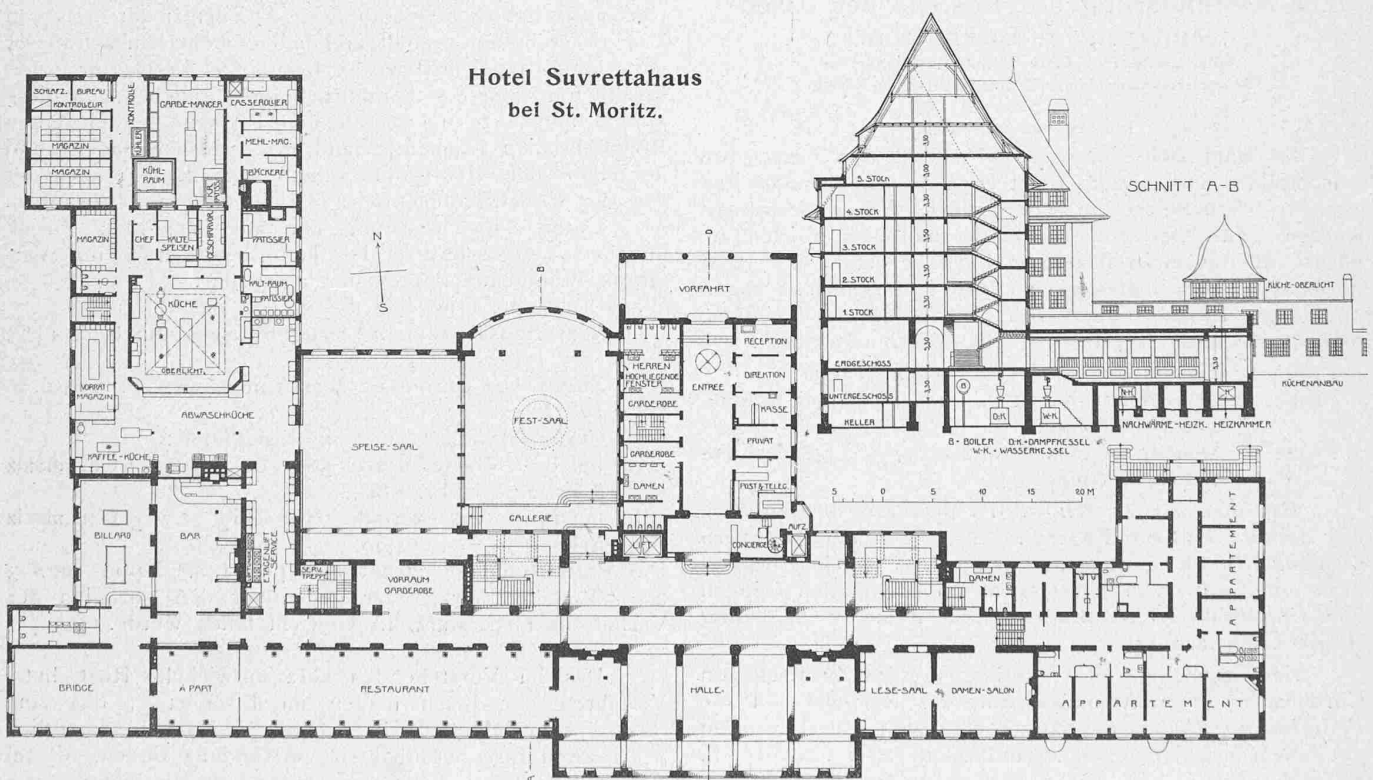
Grundriss vom Erdgeschoss. — Masstab 1:700.
